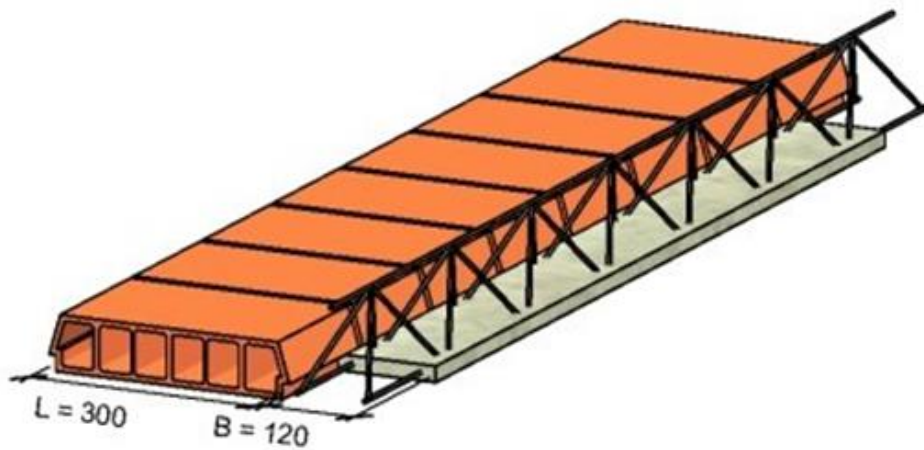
Detalhe da vigota treliçadas com preenchimento em bloco cerâmico.
